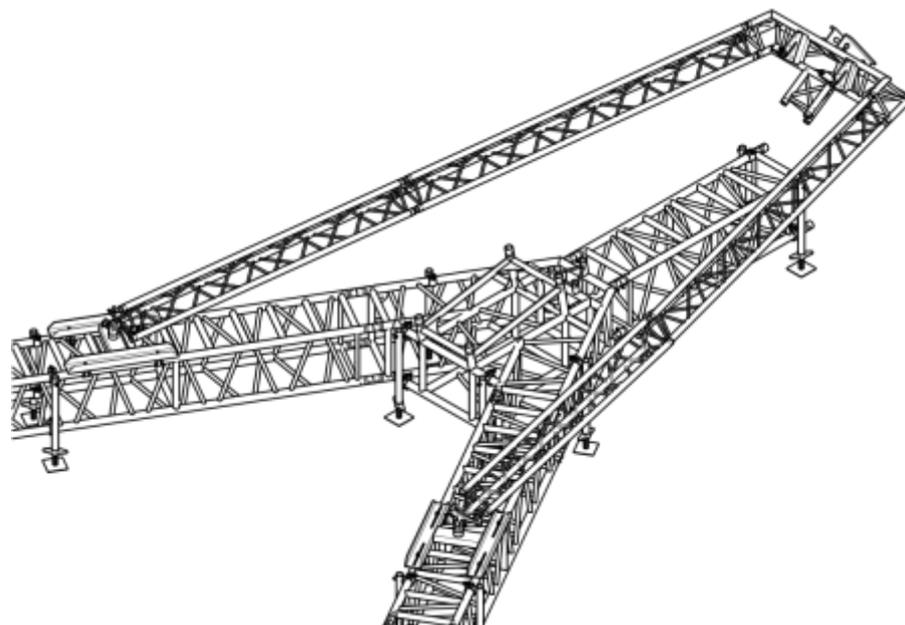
Montaggio struttura di sollevamento torre – bracci anteriori.
